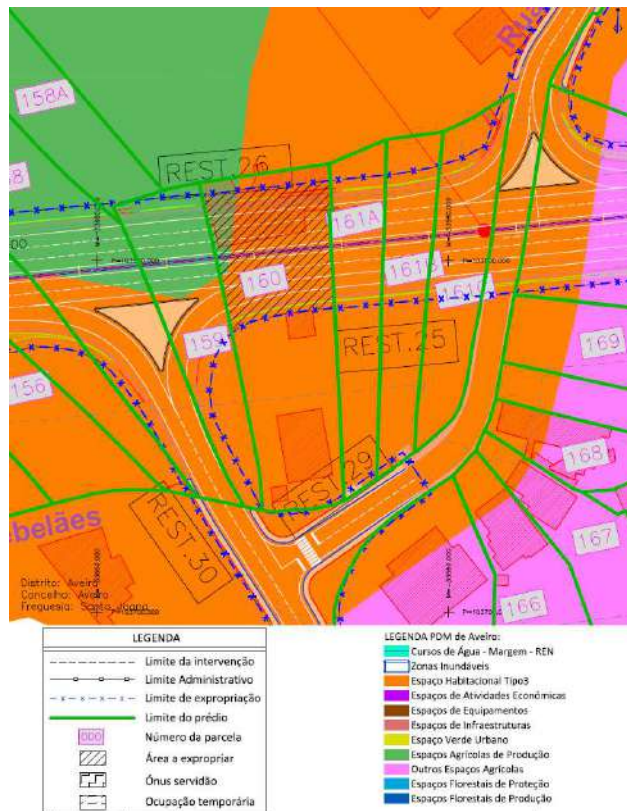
, 4.346, 4.347, 4.348 e 4.349- km 1+525- Rotunda dos Campinhos
